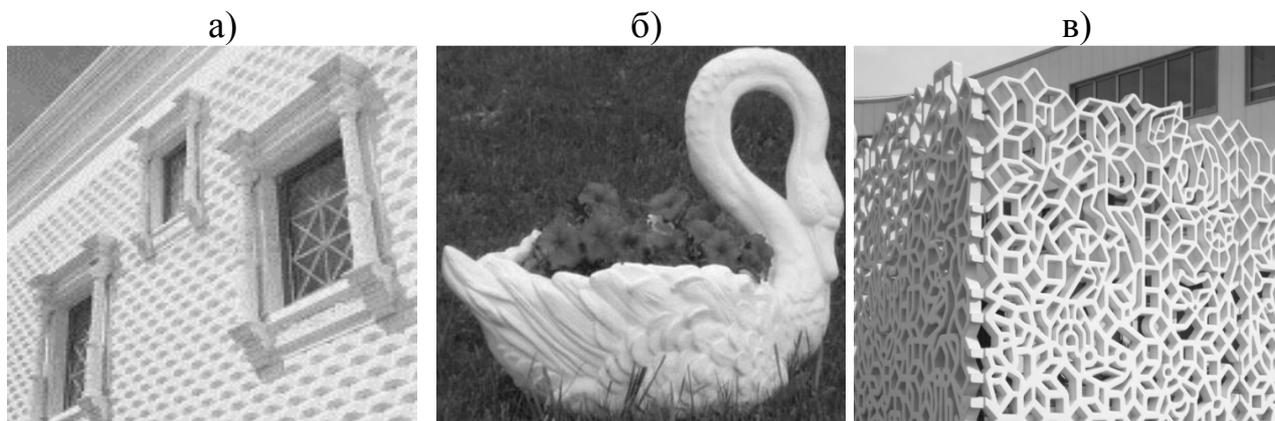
Применение белого цемента: а – отделка фасада здания; б – скульптура; в – ажурный забор
